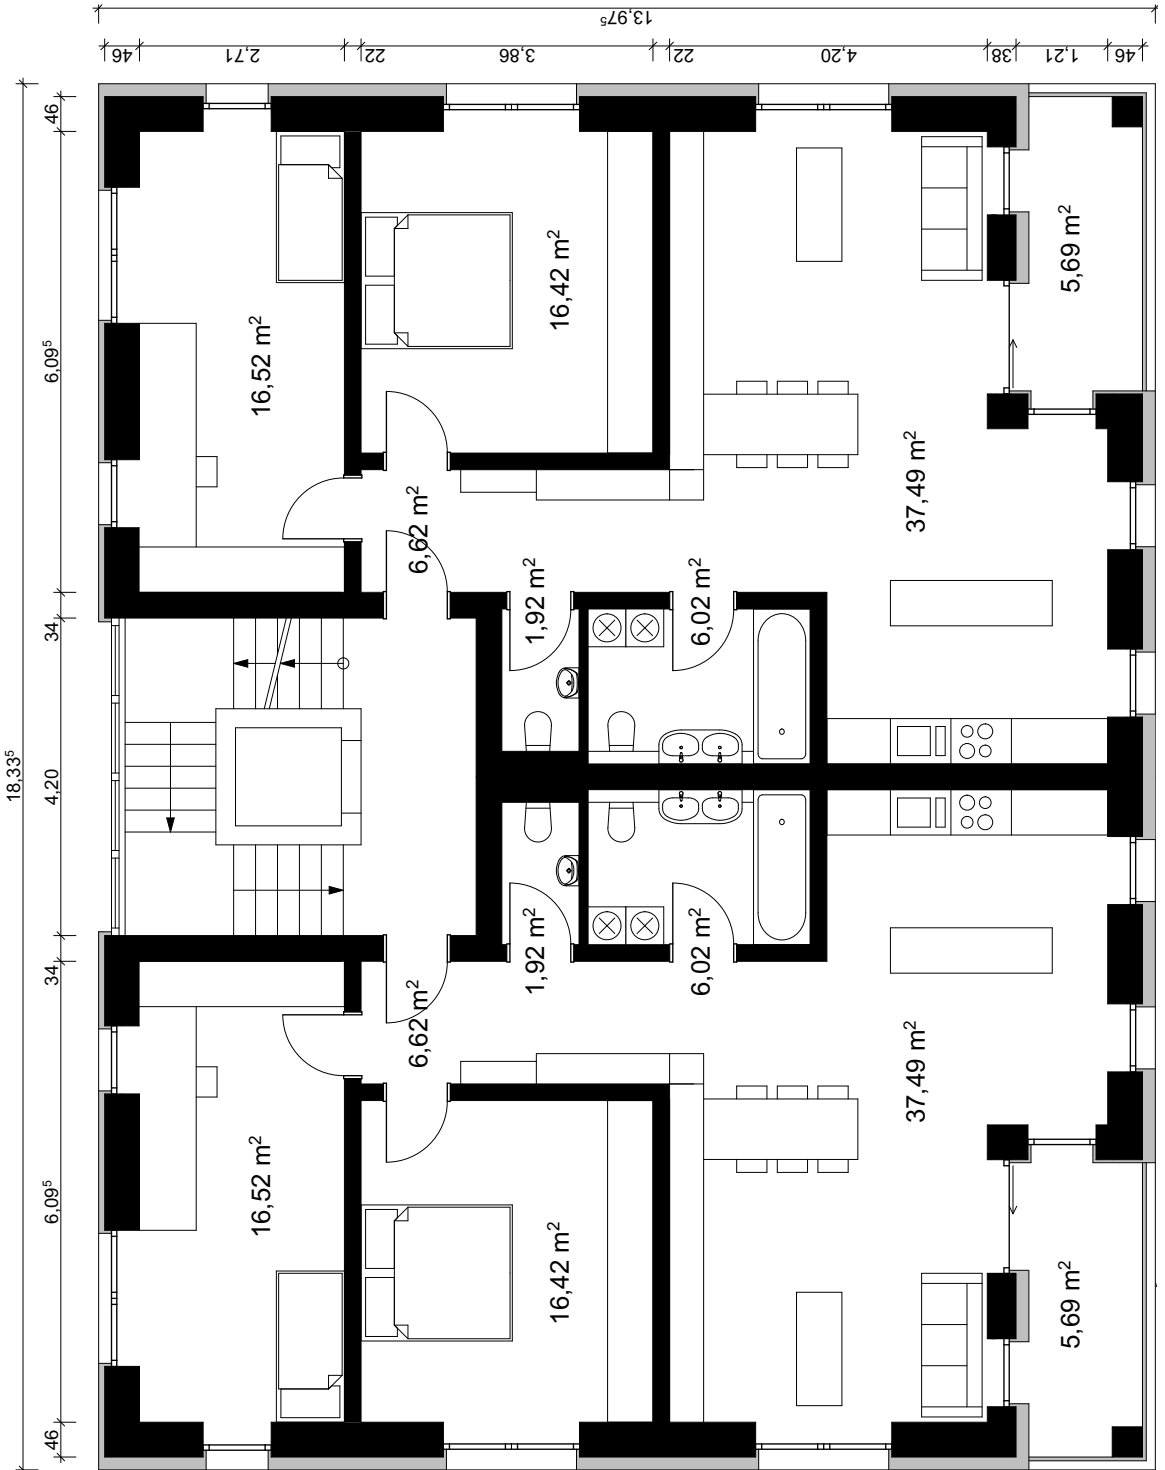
Grundriss 2. und 4. Obergeschoss M 1:100
